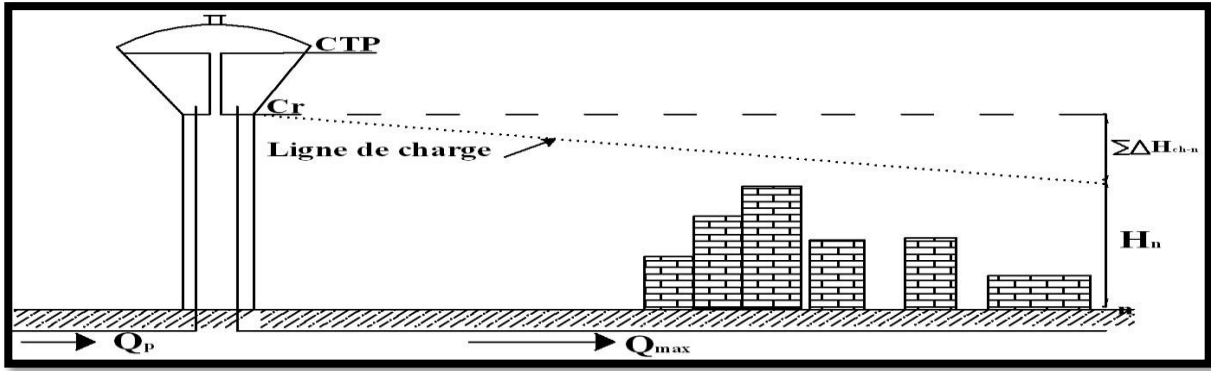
la hauteur du château d'eau par apport bâtiment.
